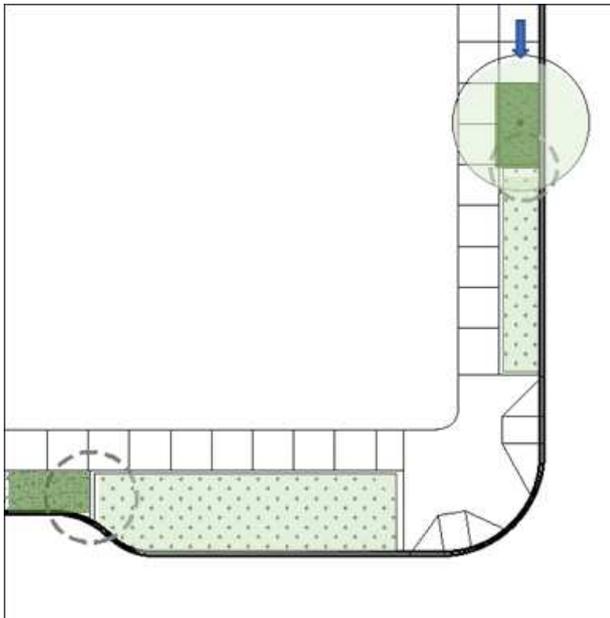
Esempio situazione accettabile: paesaggio, albero, palo o barriera indica il margine della struttura. Fonte: Storm Water Management (SWMM)
